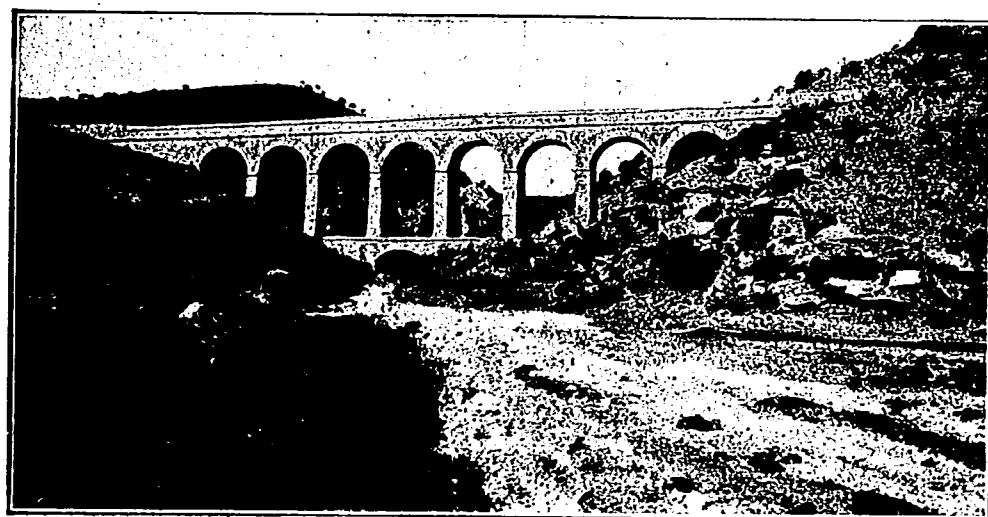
Puente acueducto de la Retuerta, Kilómetro 36.
